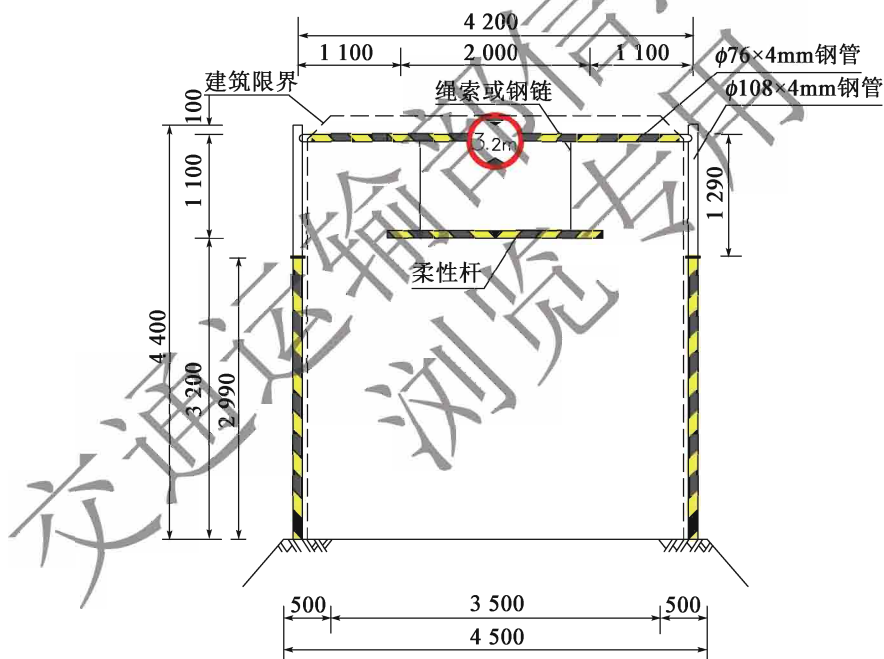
警示限高架结构示意图(尺寸单位: mm)
